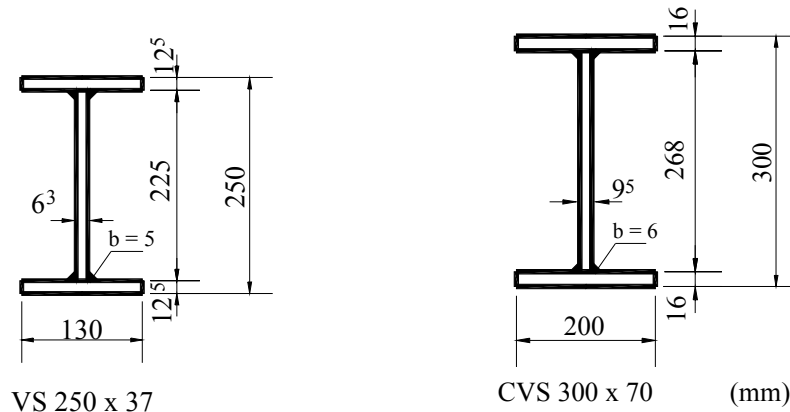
Respectivamente, perfis da viga e do pilar
